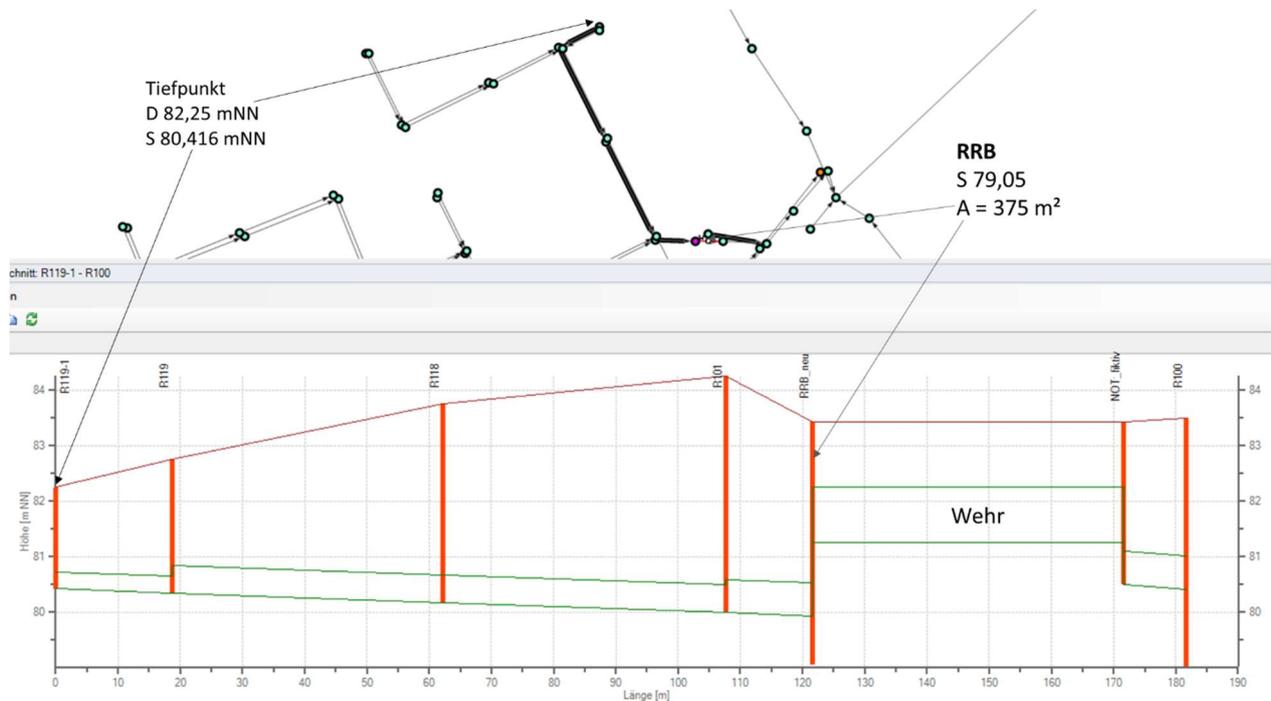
Variante 3: Längsschnitt von Geländetiefpunkt über RRB und Wehr
